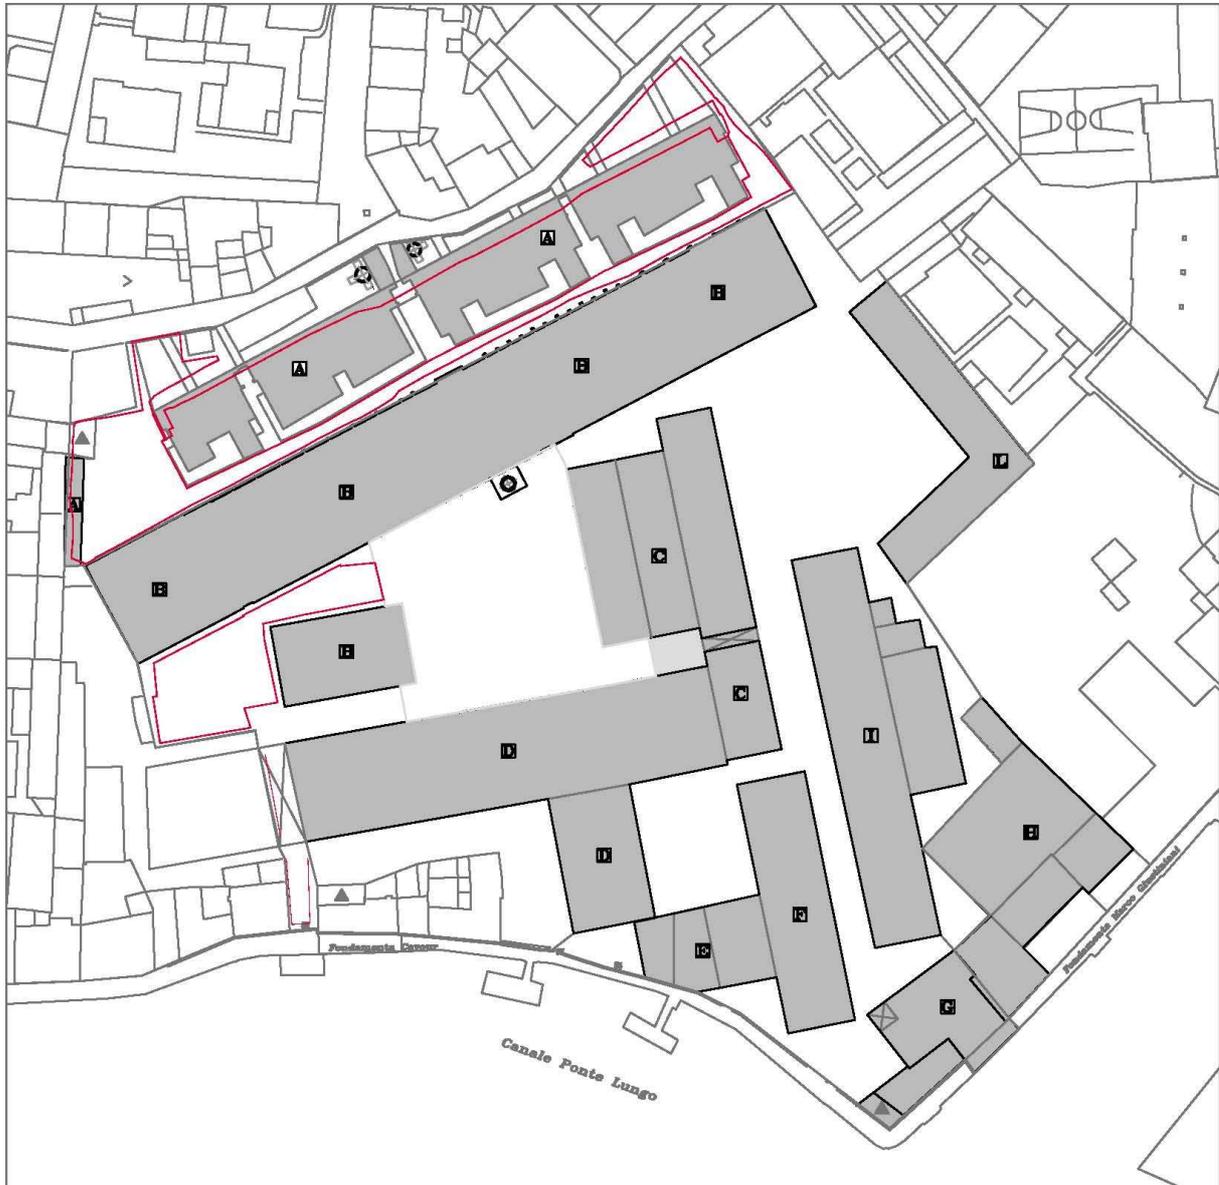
Perimetrazione del secondo lotto di bonifica con palancole a rinforzo delle fondazioni
